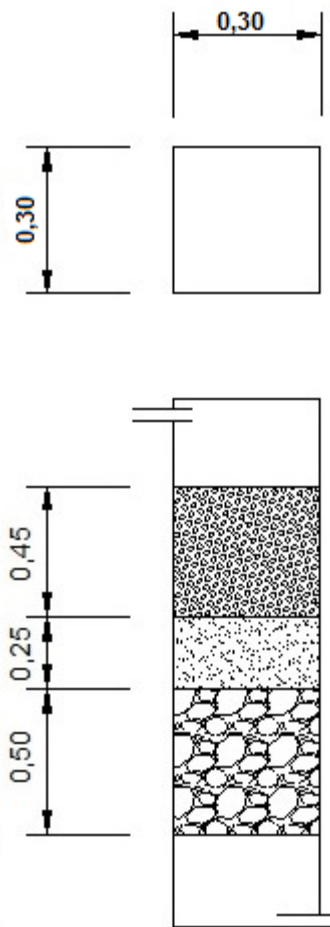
Corte e planta do filtro de dupla camada (medidas em metros)
